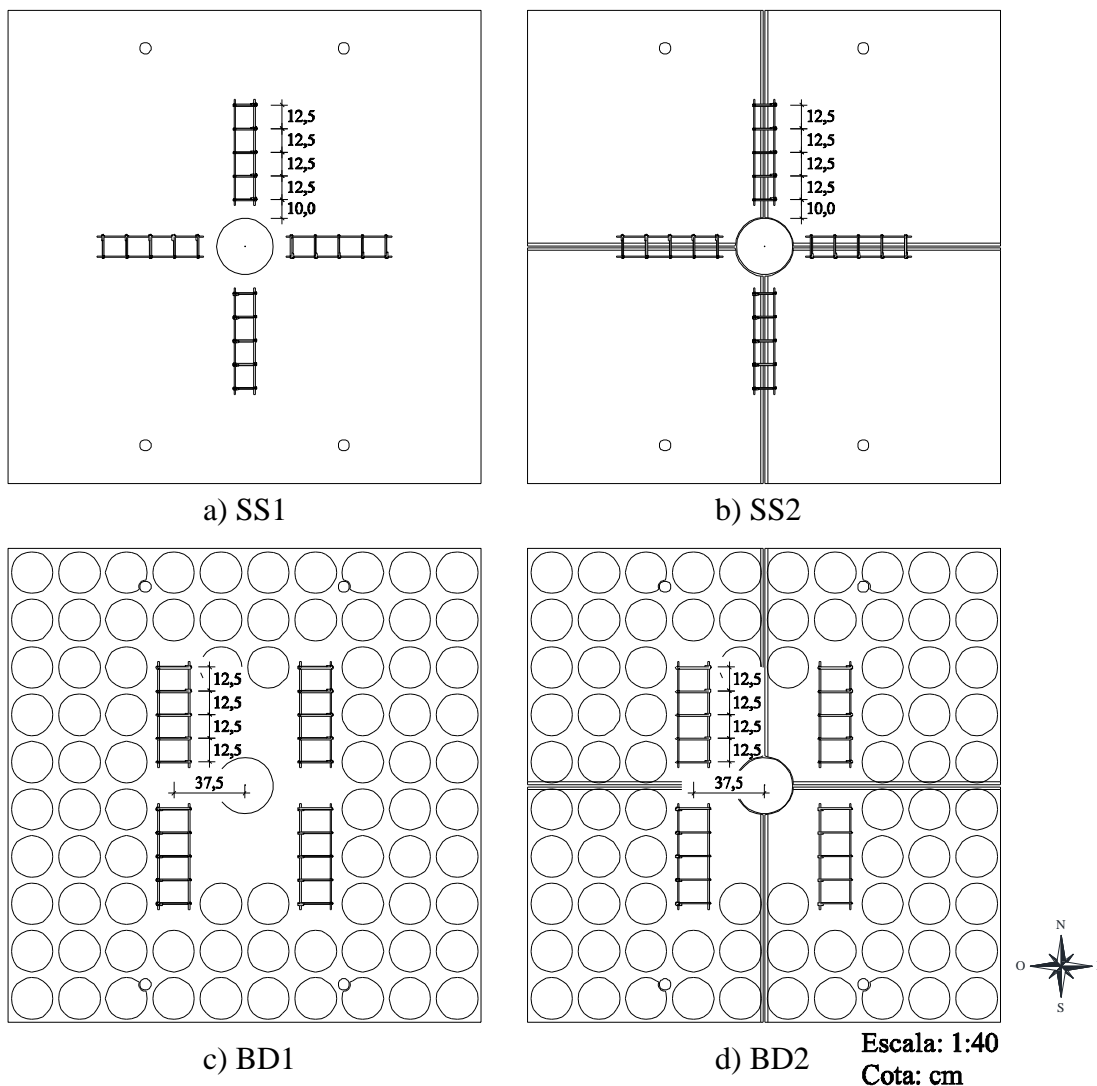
Disposição dos estribos nas lajes – vista em planta
